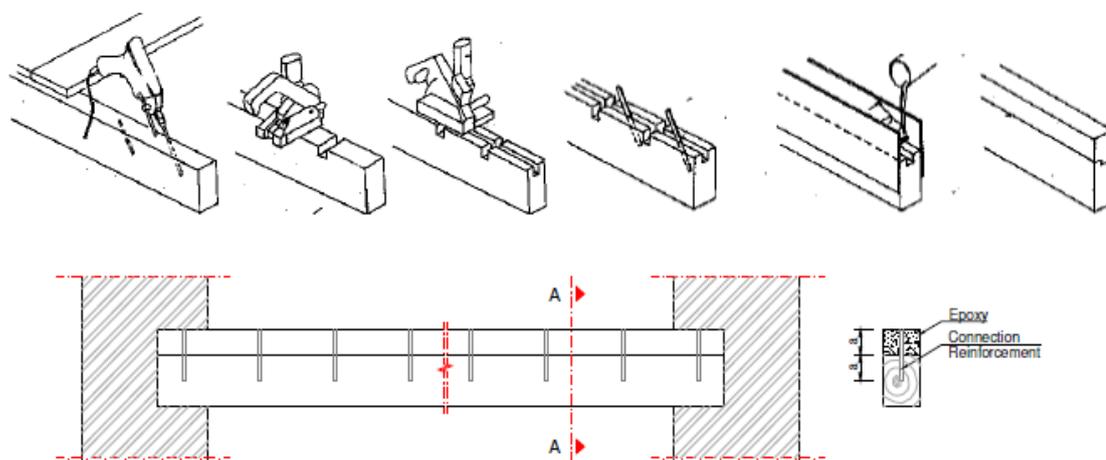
Reforço de seção de viga através da reconstrução da face superior com colas epoxídicas e ligadores (Arriaga, 2002) (Pinto, 2008)
